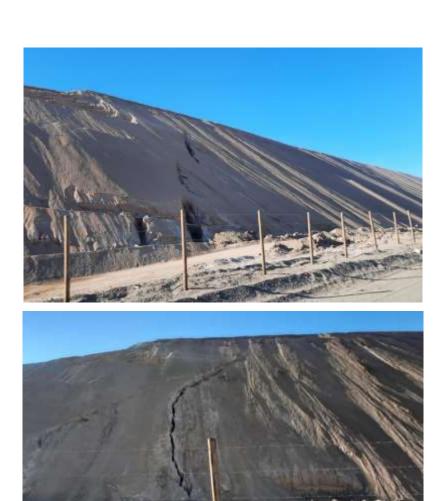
Vista Grieta en Muro de Tranque de Relaves Mantos Blancos
